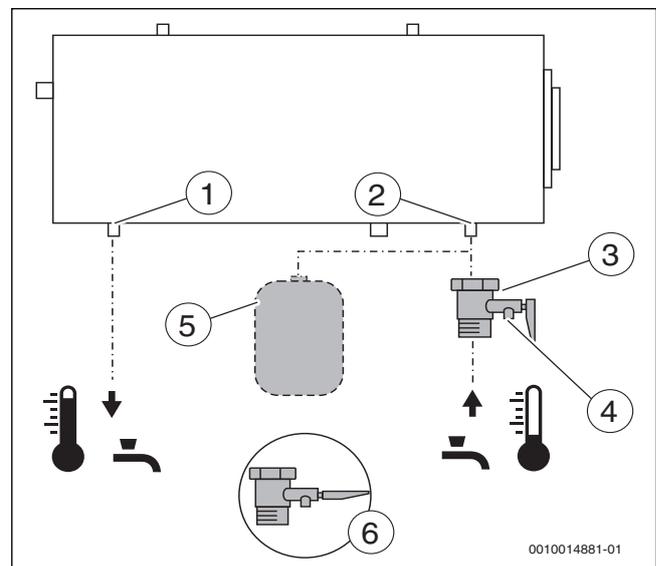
Raccordement des conduites d'eau chaude sanitaire
